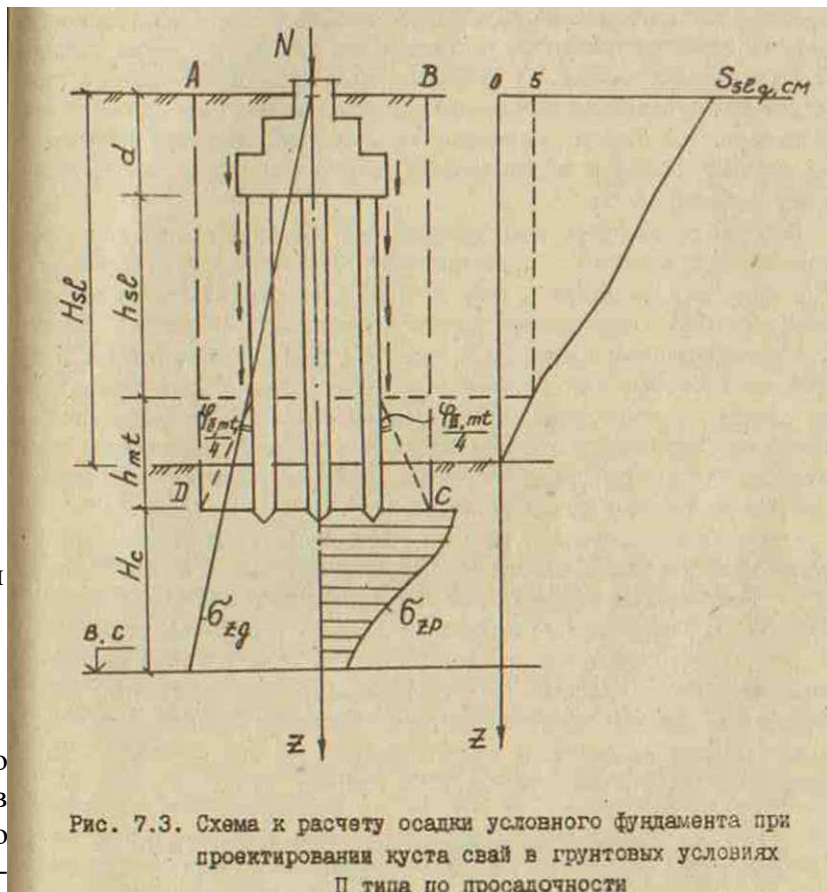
Схема к расчету осадки условного фундамента при проектировании куста свай в грунтовых условиях II типа по просадочности
